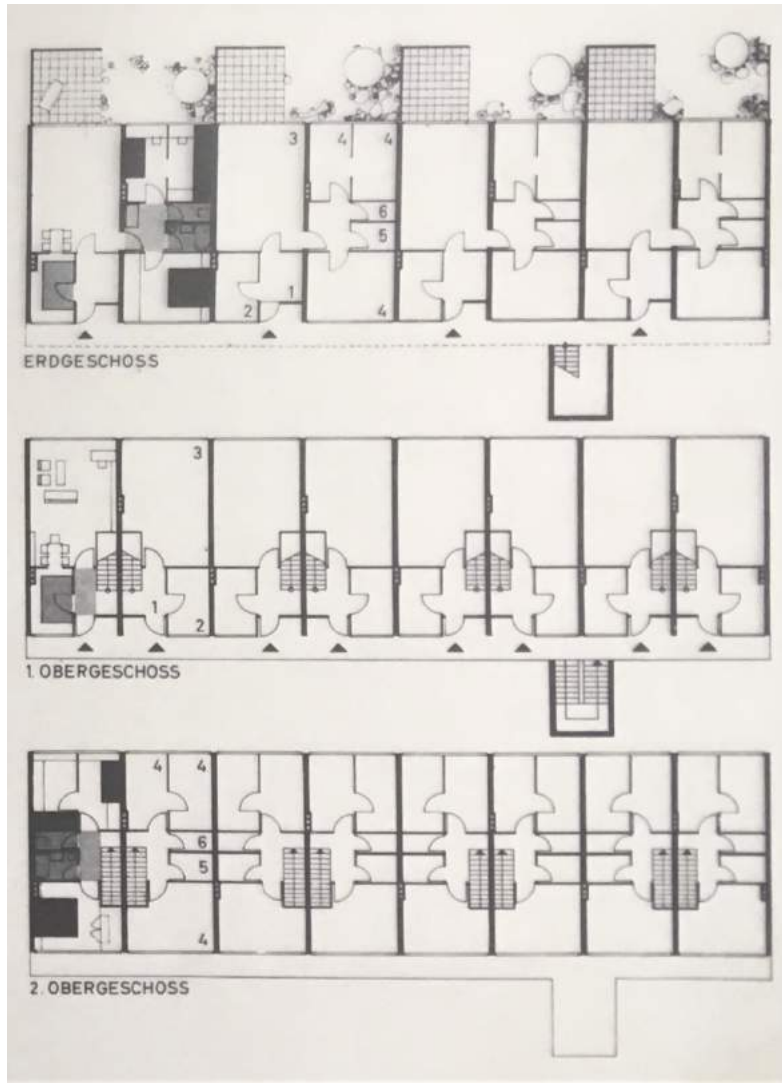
Grundriss Mehrfamilienhaus, Siedlung Böhlerwerk, 1959
